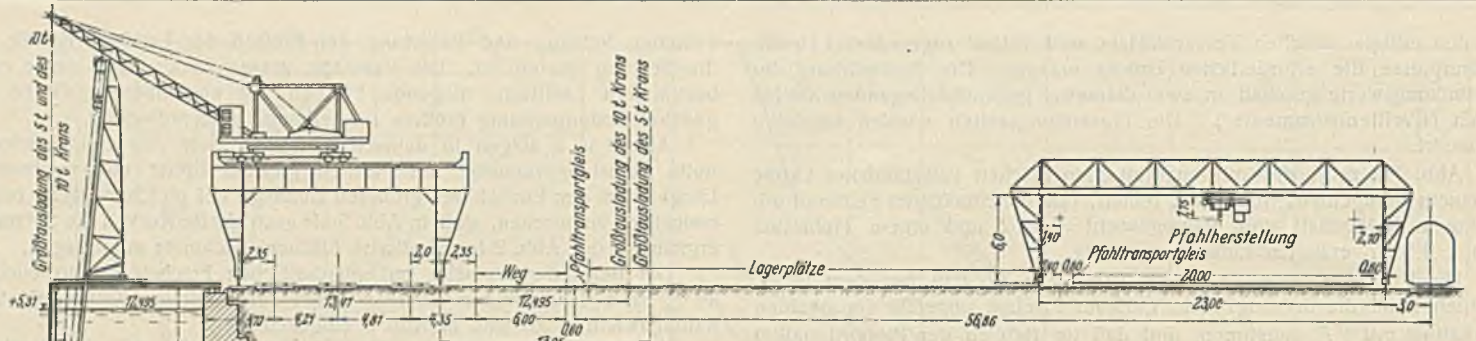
Querschnitt für die Baustelleneinrichtung.
